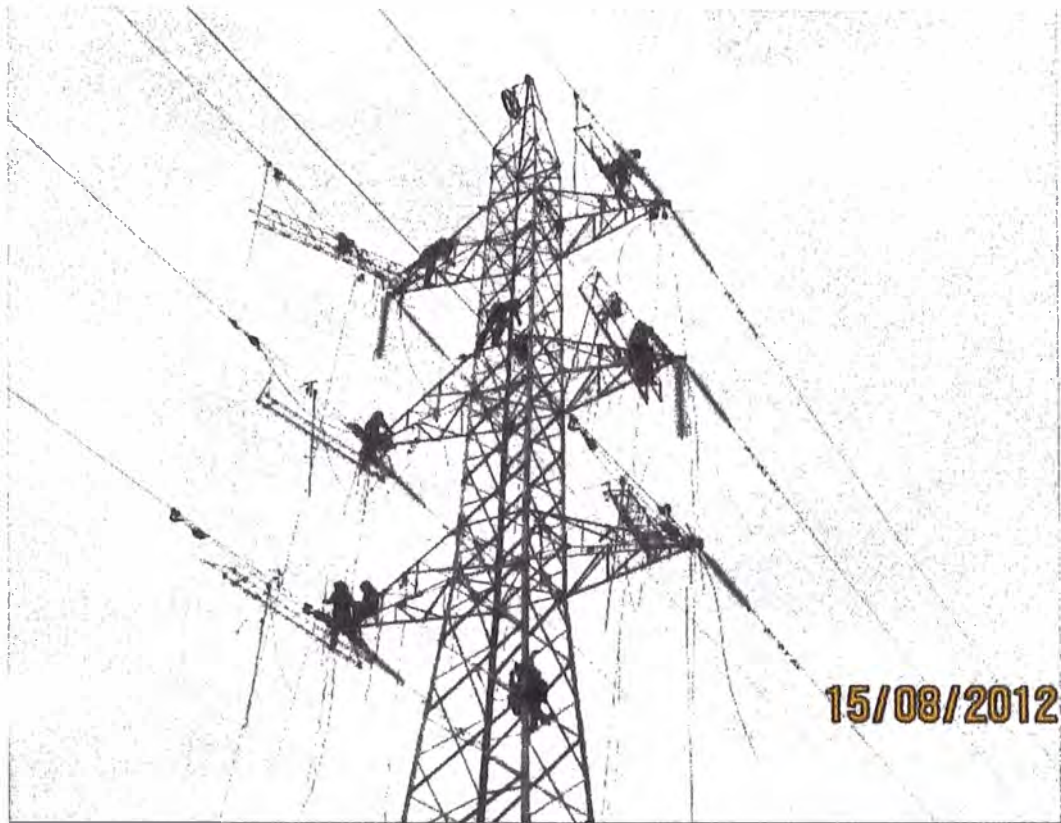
Instalación de cadenas de aisladores en una torres de anclaje
